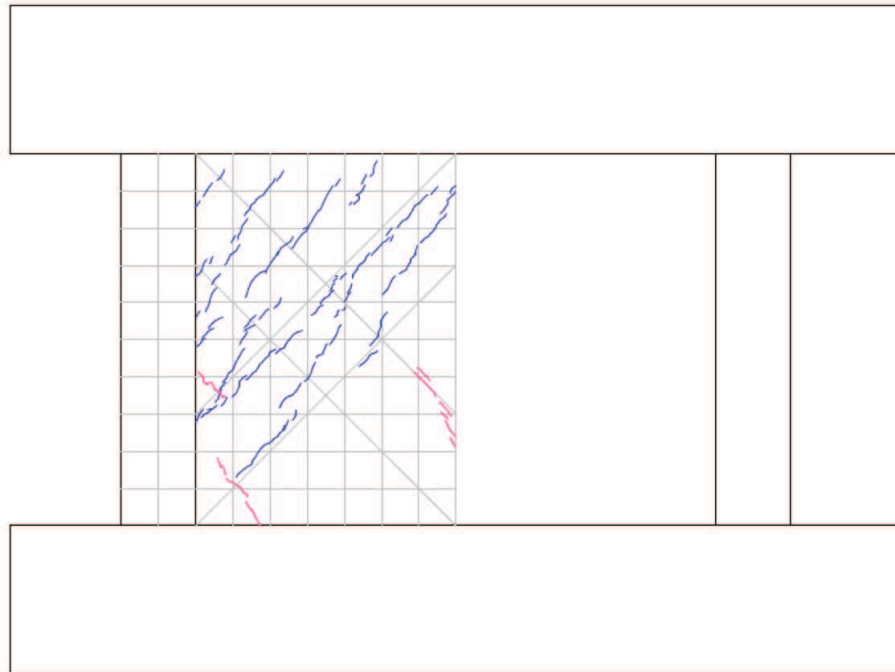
試験体 S-13-D I 事前加力終了時 (0.75/1000rad.) ひび割れ図
